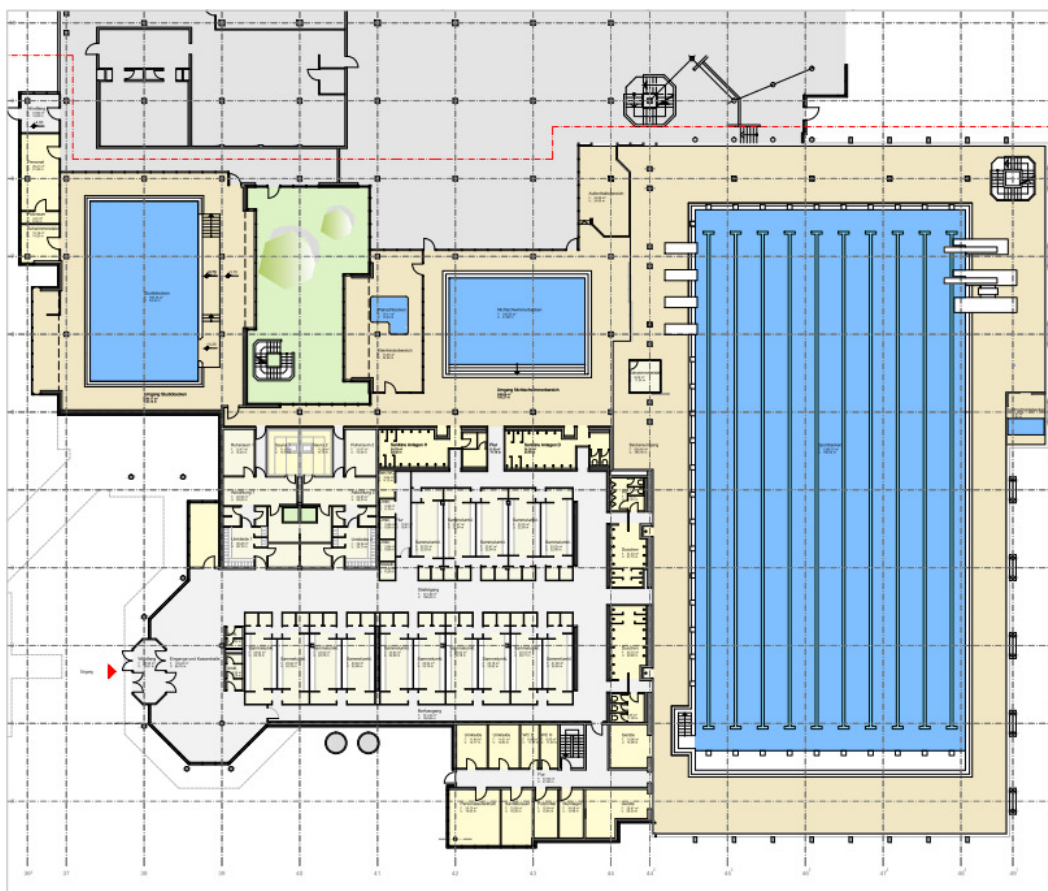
Grundriss Badeebene „Instandhaltungssanierung“
